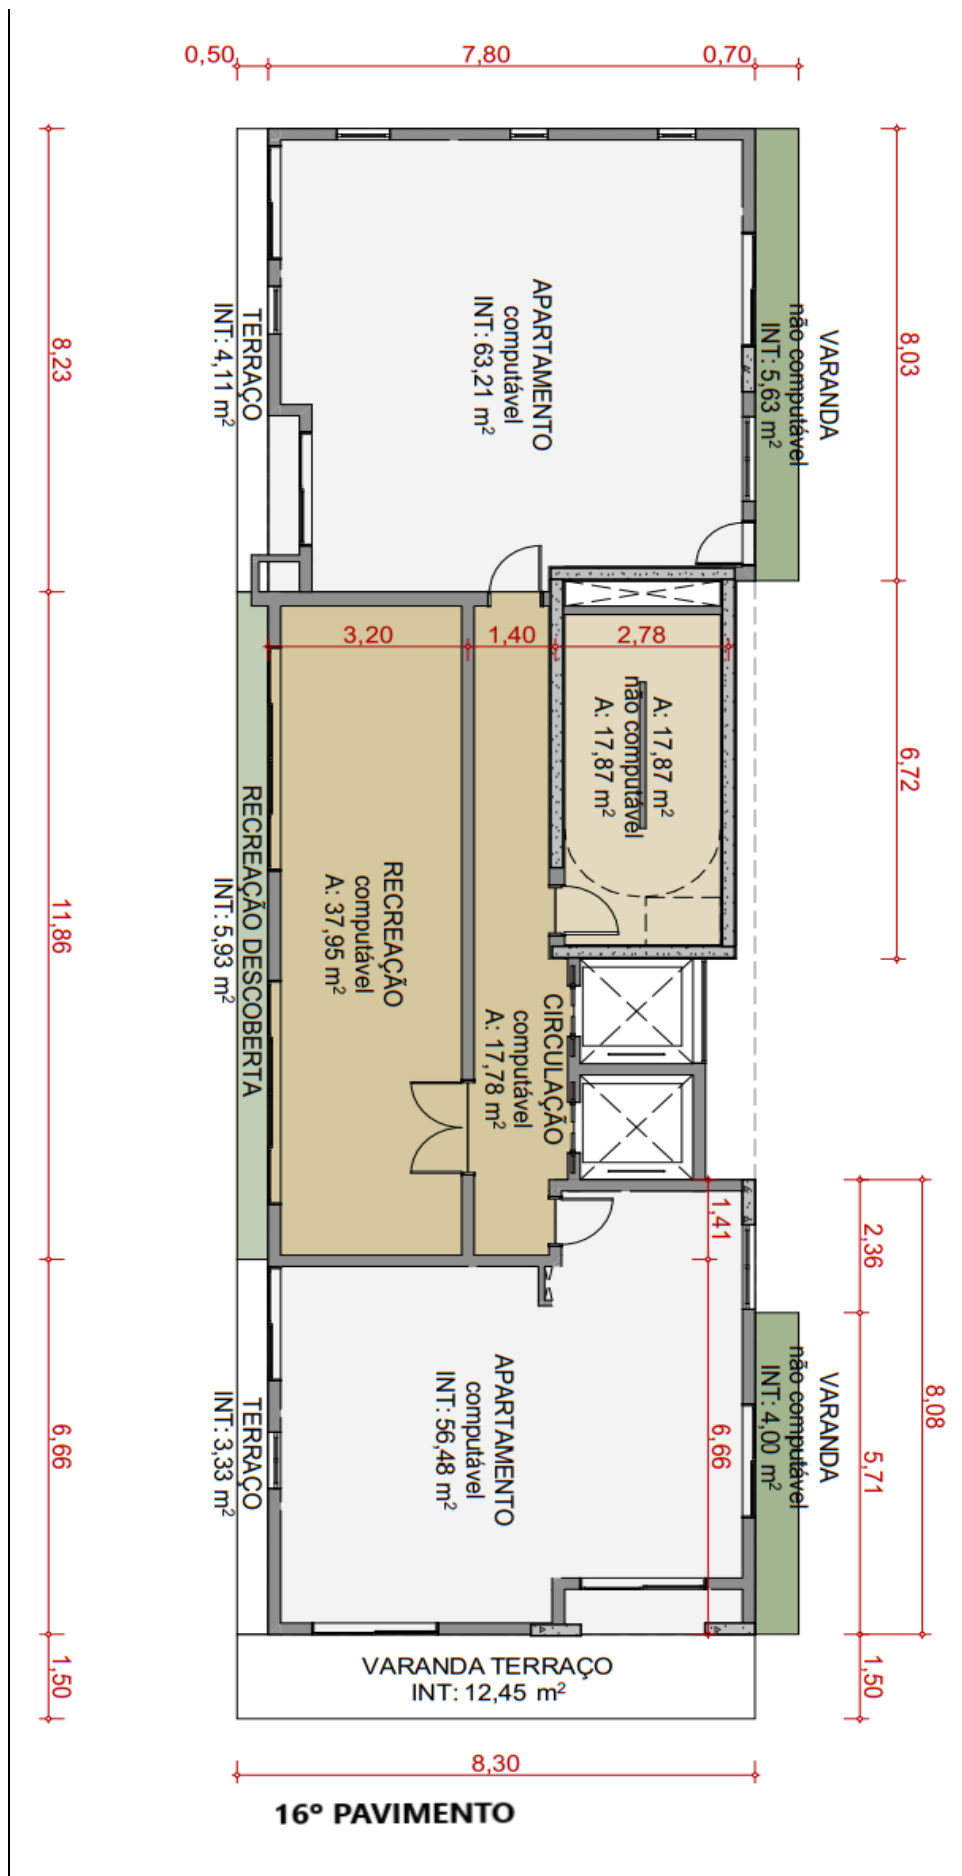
Planta do 16º Pavimento do Condomínio Sintropia Sky Garden.
